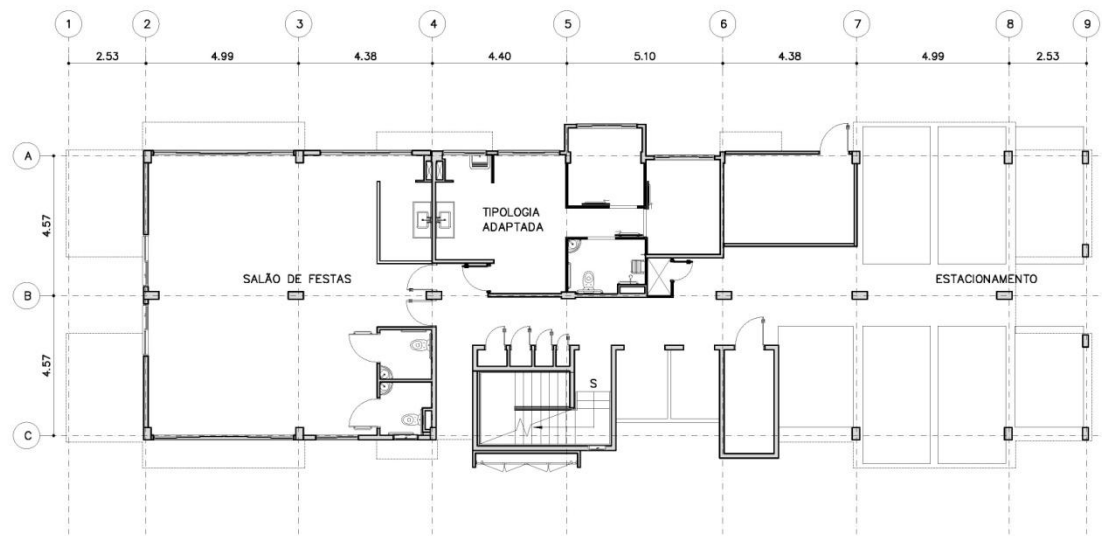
Planta Pavimento Térreo (V052-3) - sem escala; Fonte: Fernando Lima a partir de projeto da CDHU.
